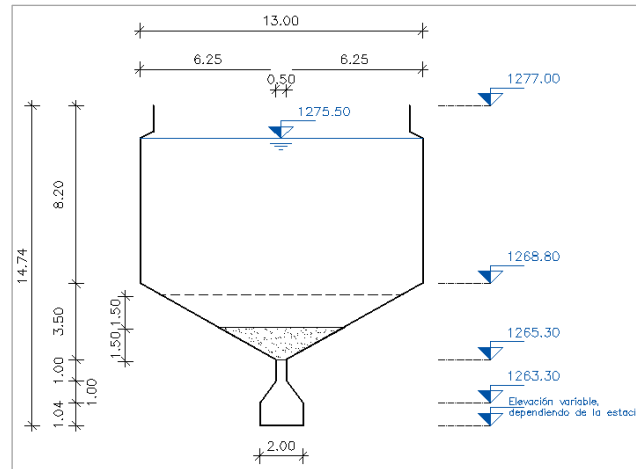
Sección de la cámara para el sistema de lavado BIERI.
